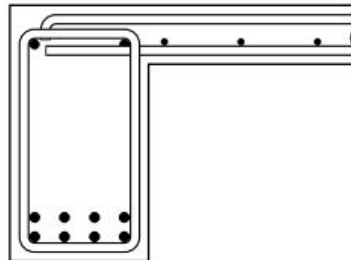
Ejemplo de viga de hormigón con armadura de acero.
